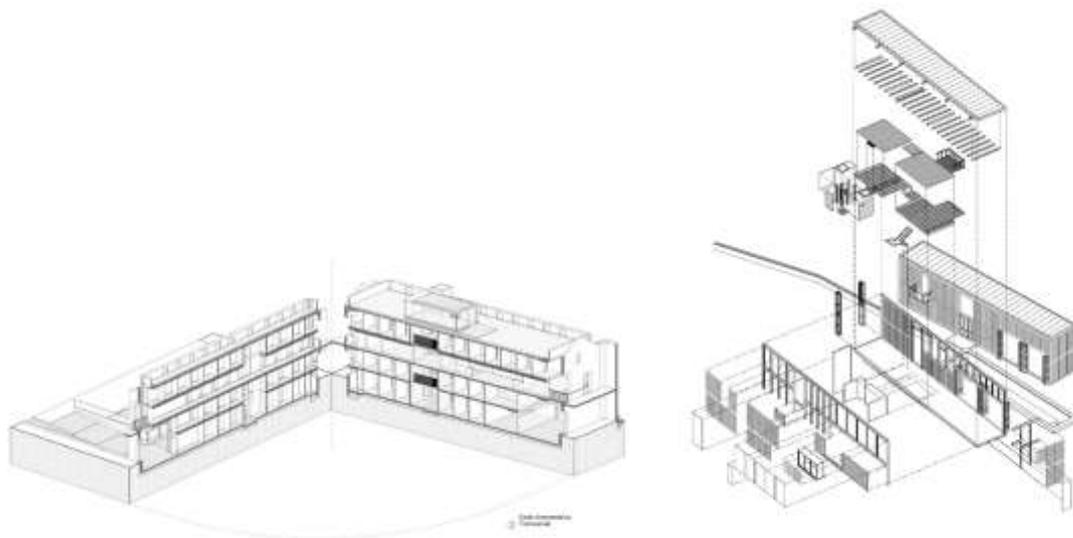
Representação axonométrica em corte (esquerda) e representação axonométrica explodida (direita)
